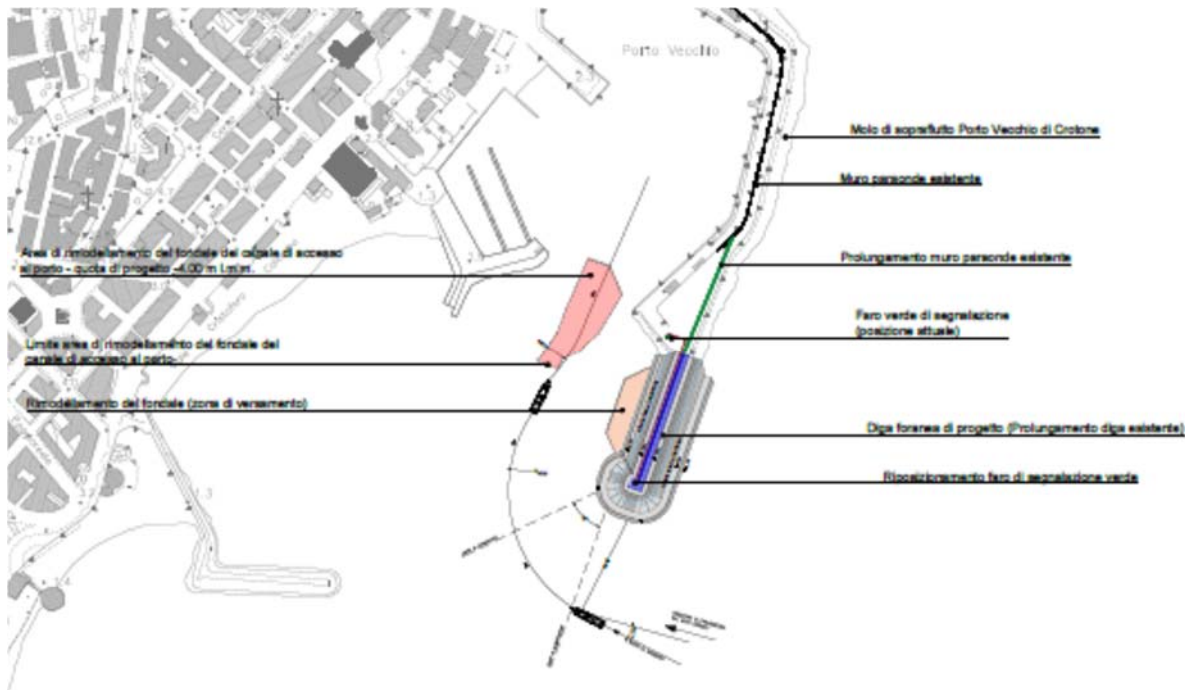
Planimetria di progetto della Proposta di ATF
